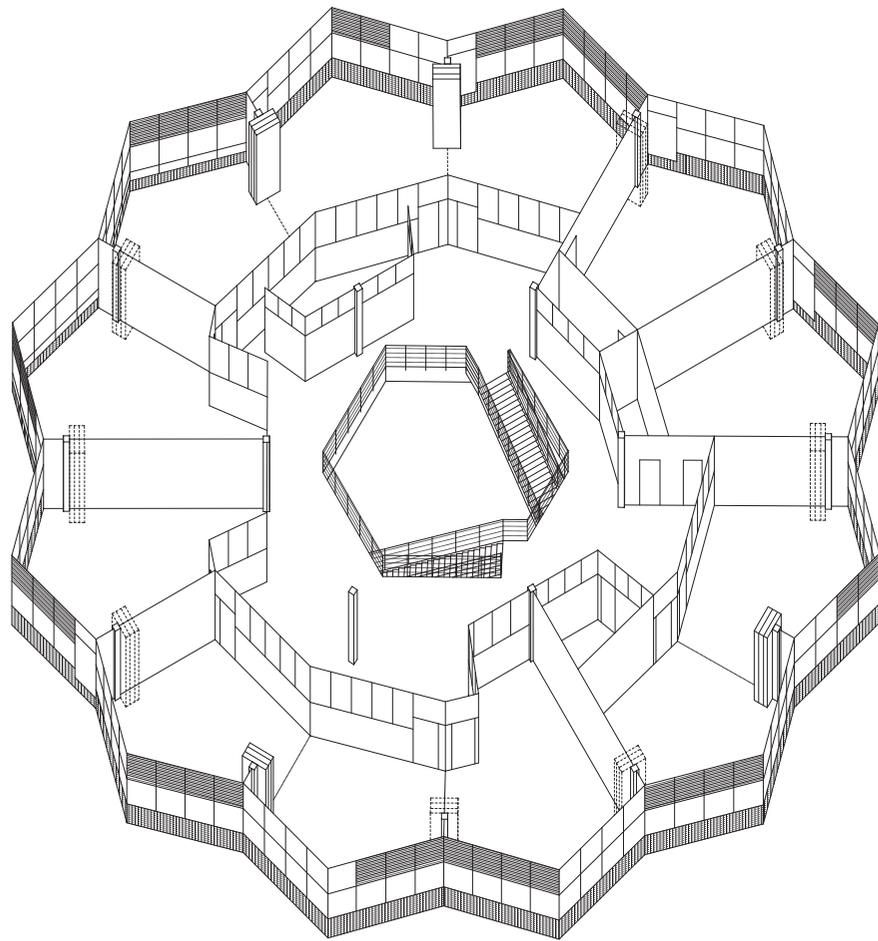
Grundriss (Auszug), Grundschule, Ringsted, DK (Entwurf), 2005
